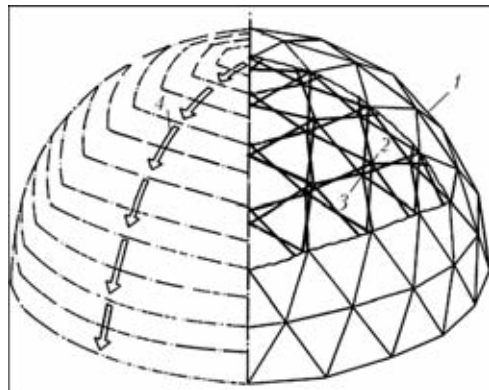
Схема складывающейся конструкции [10]: 1 — сферическая конструкция; 2, 3 — точки шарнирного закрепления; 4 — направление складывания
